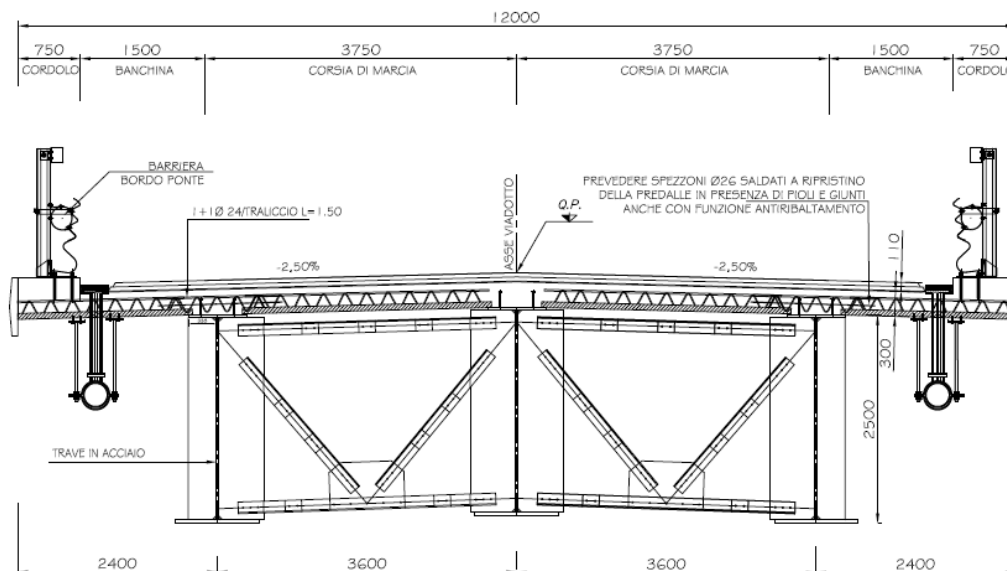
Viadotto Ozzoretto: sezione trasversale tipo dell'impalcato (H=2,5 m)
